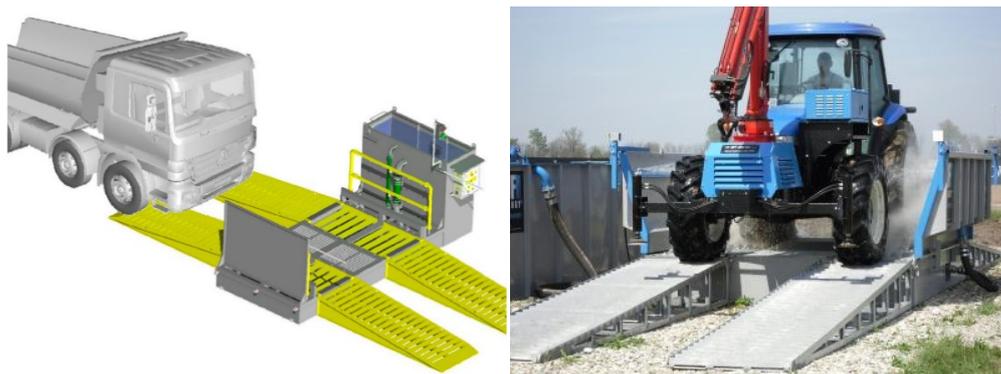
Impianto di lavaggio mezzi tipo B nelle aree di lavorazione locali
